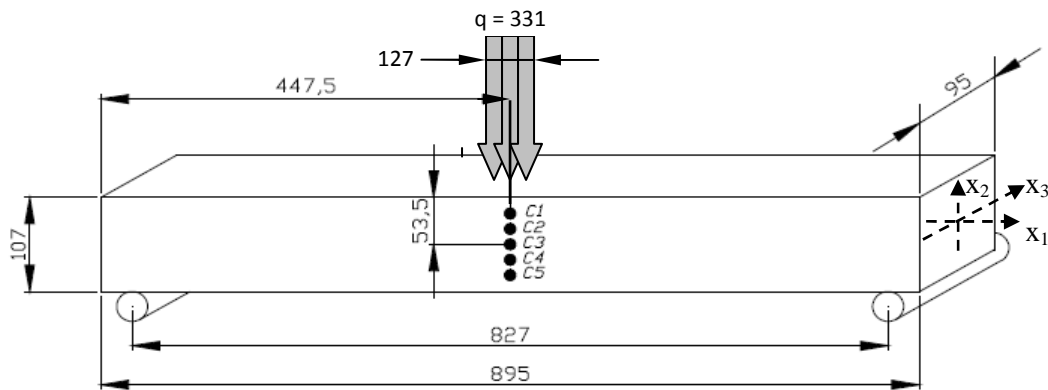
Desenho da viga e do carregamento aplicado (dimensões em mm; carga do pistão (q) linearmente distribuída sobre viga (Kgf/mm); (Dutra, 2009).
